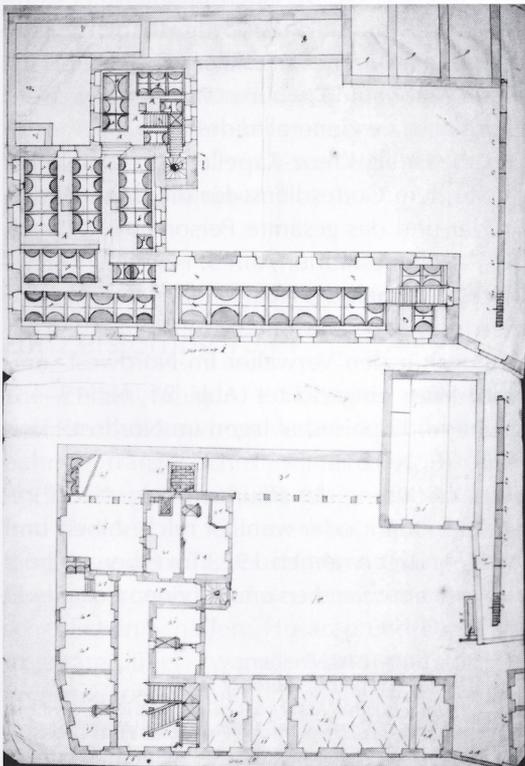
(links): Freiburg, Peterhof. Grundriss des Unter- und Erdgeschosses, um 1806.
